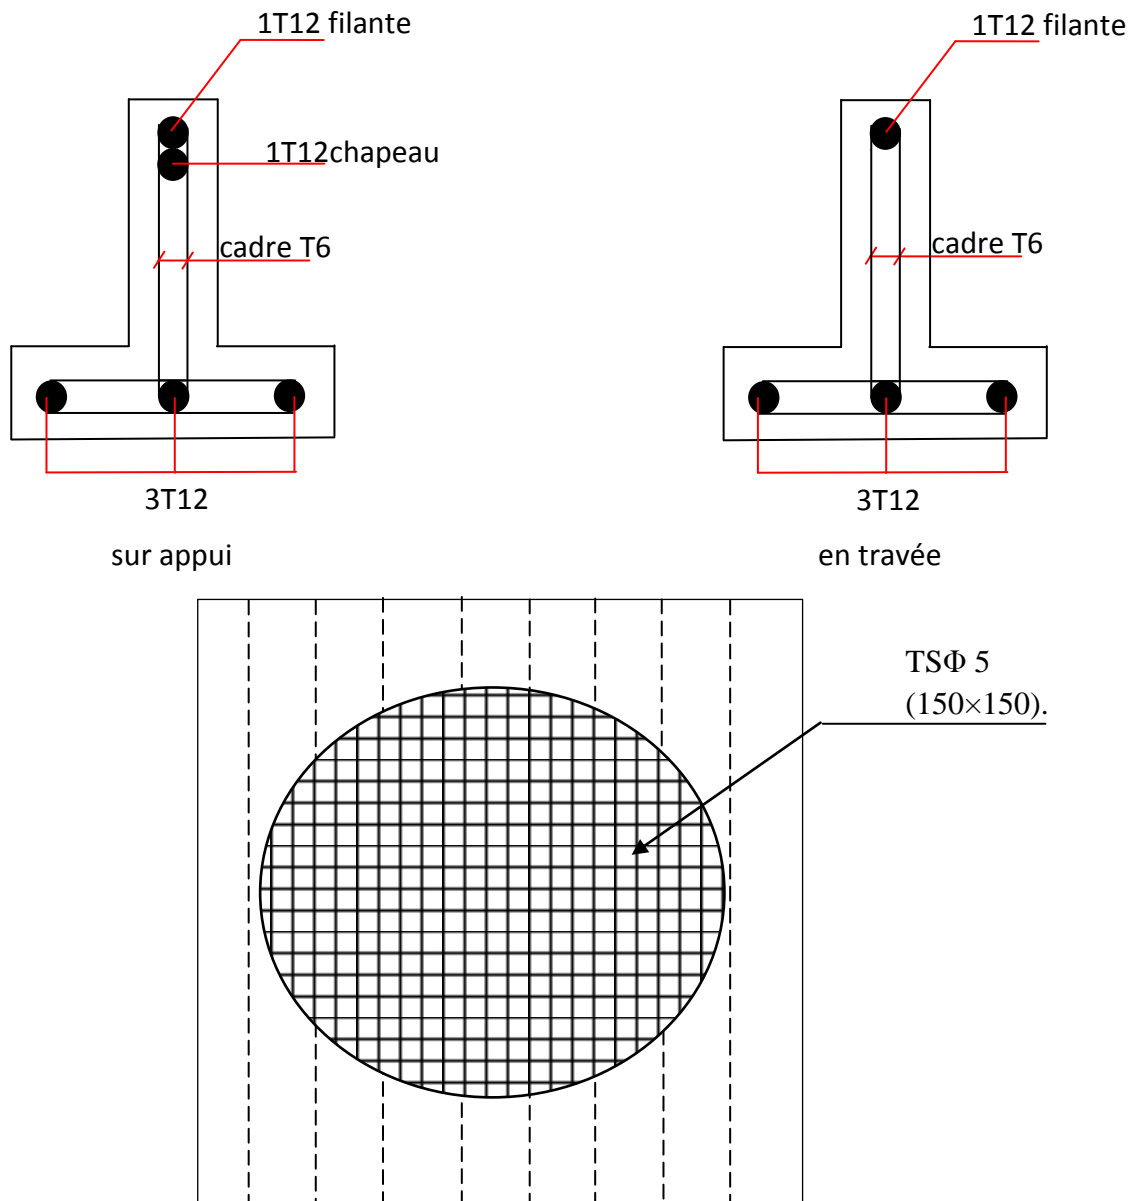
schéma de ferrailage des poutrelles du plancher étage courant .
